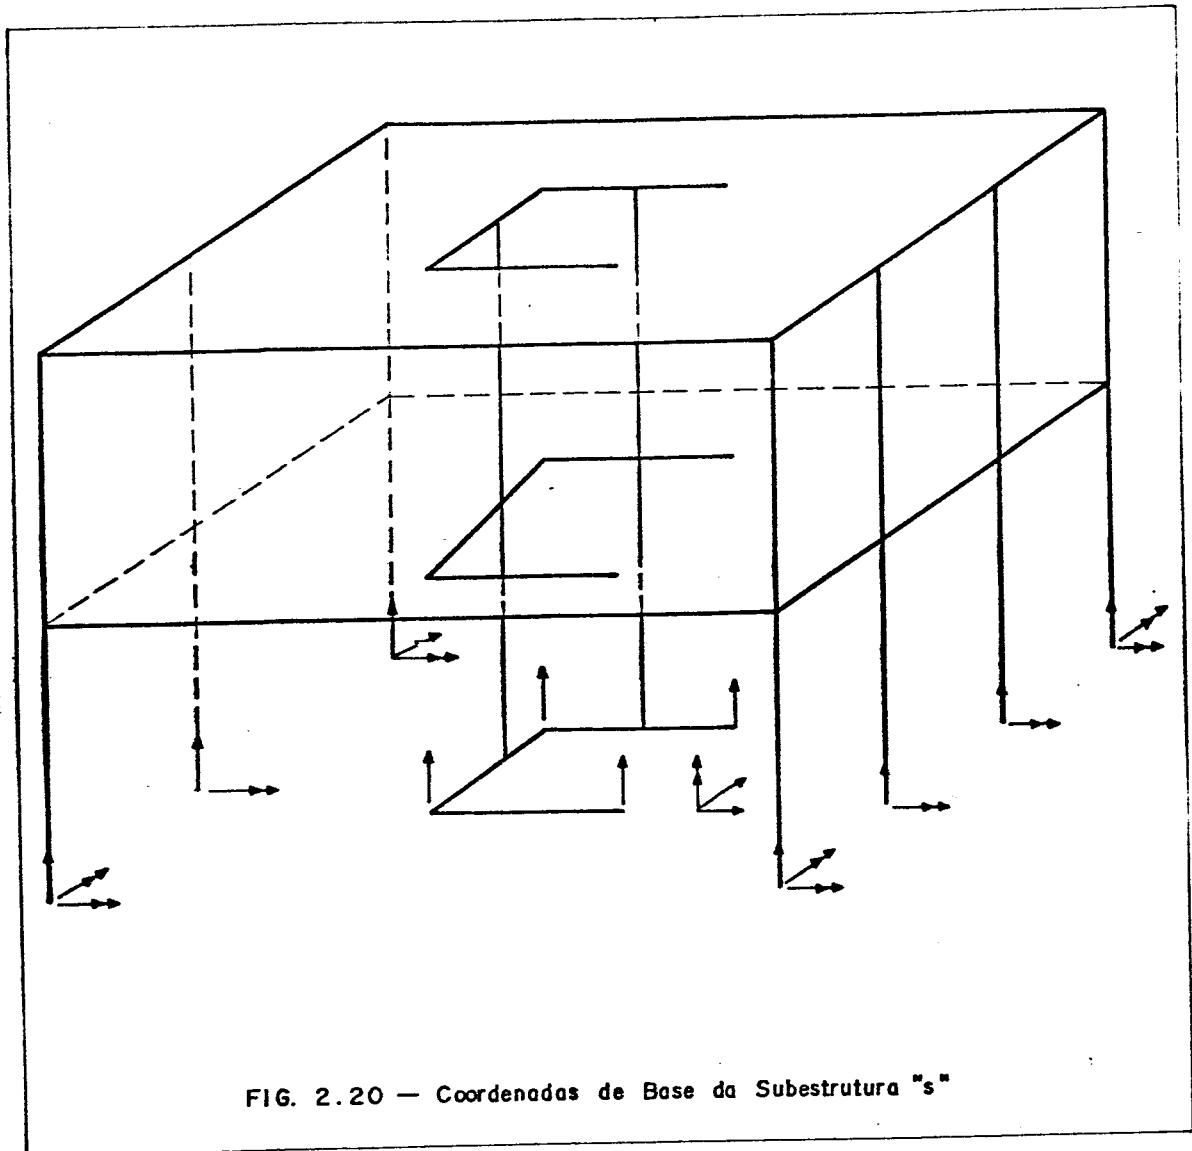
Coordenadas de Base da Subestrutura "s"
